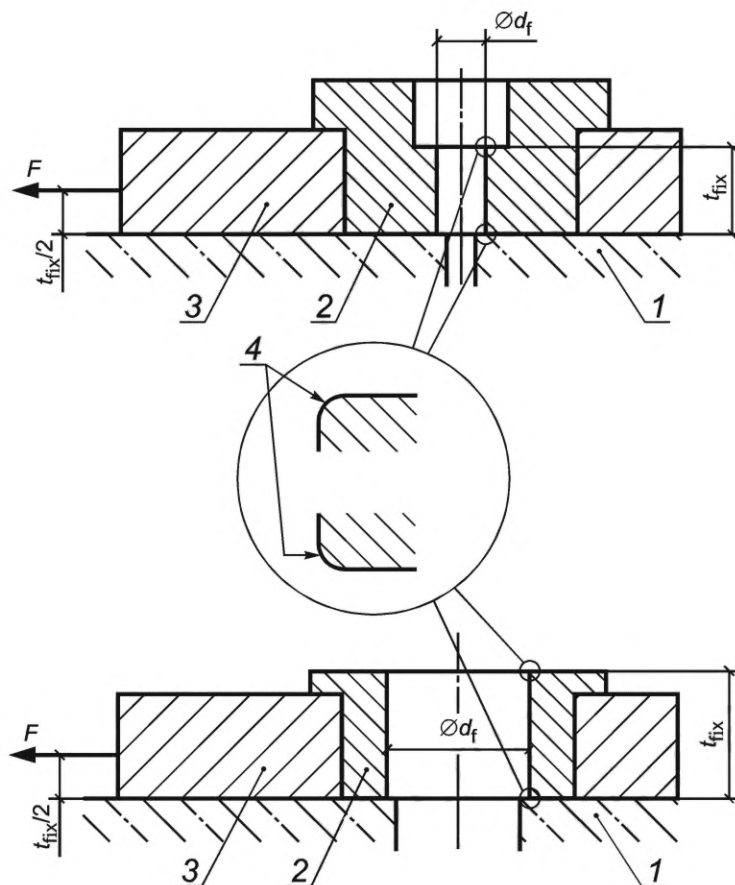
Принципиальная схема стенда для испытания анкера на вырыв
